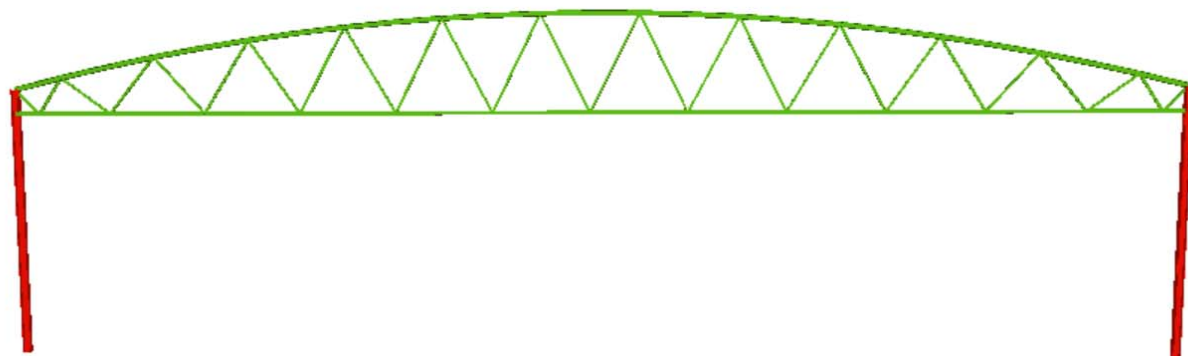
Pórtico tipo de la estructura principal. Fuente: Propia
